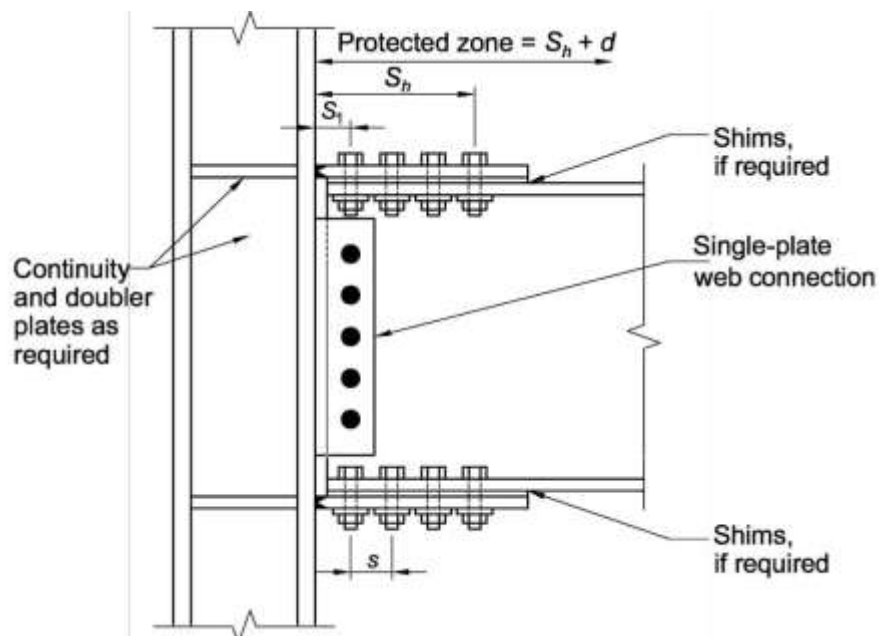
Conexión Bolted Flange Plate (AISC, AISC-358-10, 2014)
